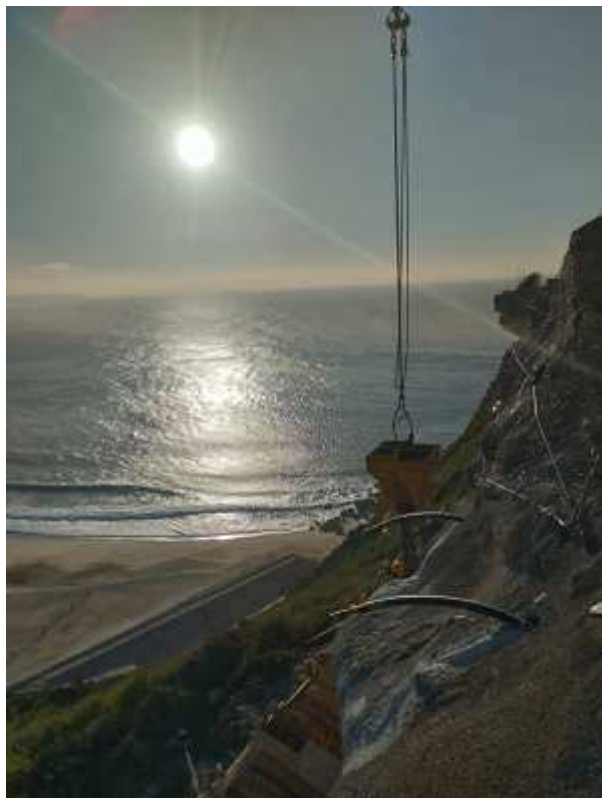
Betonagem de Montantes Verticais 1ª Fase
